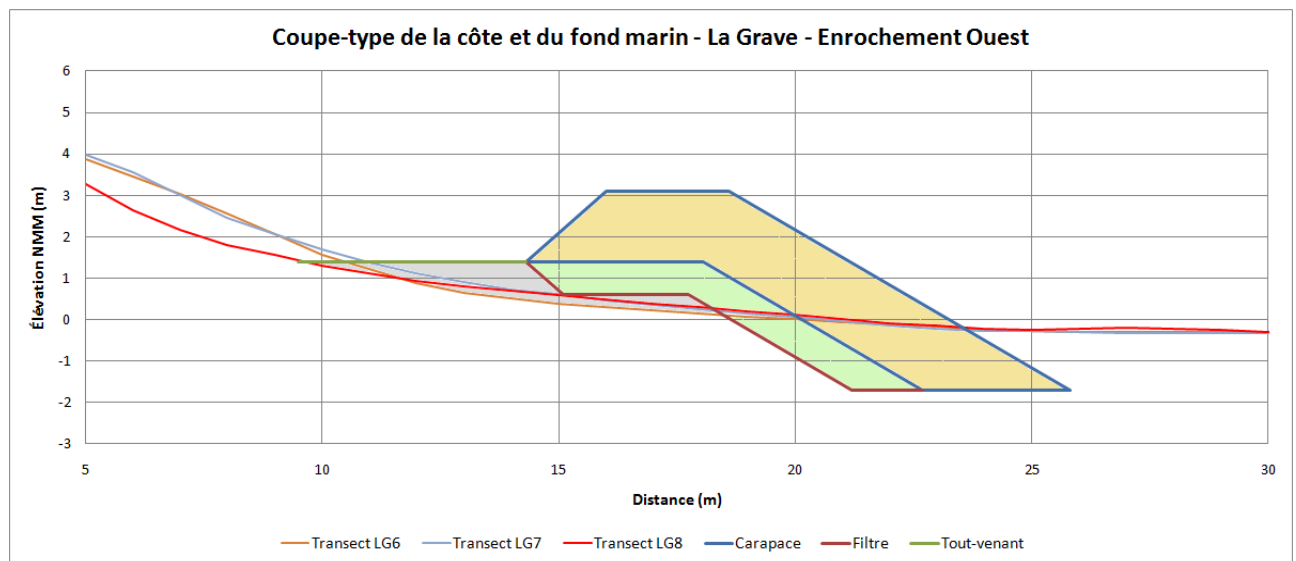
Coupe type d'une protection en enrochement de la partie ouest de La Grave
